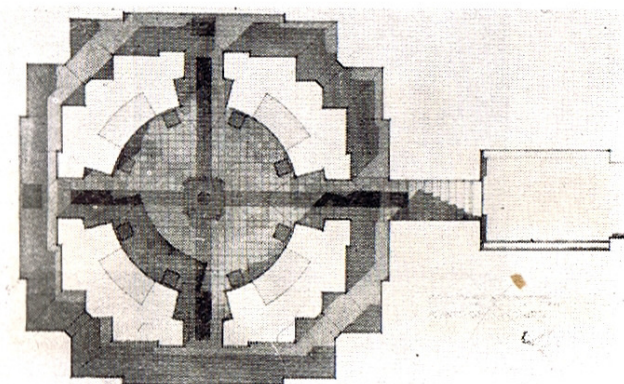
Rotonda del Cementerio Central — Planta de la
